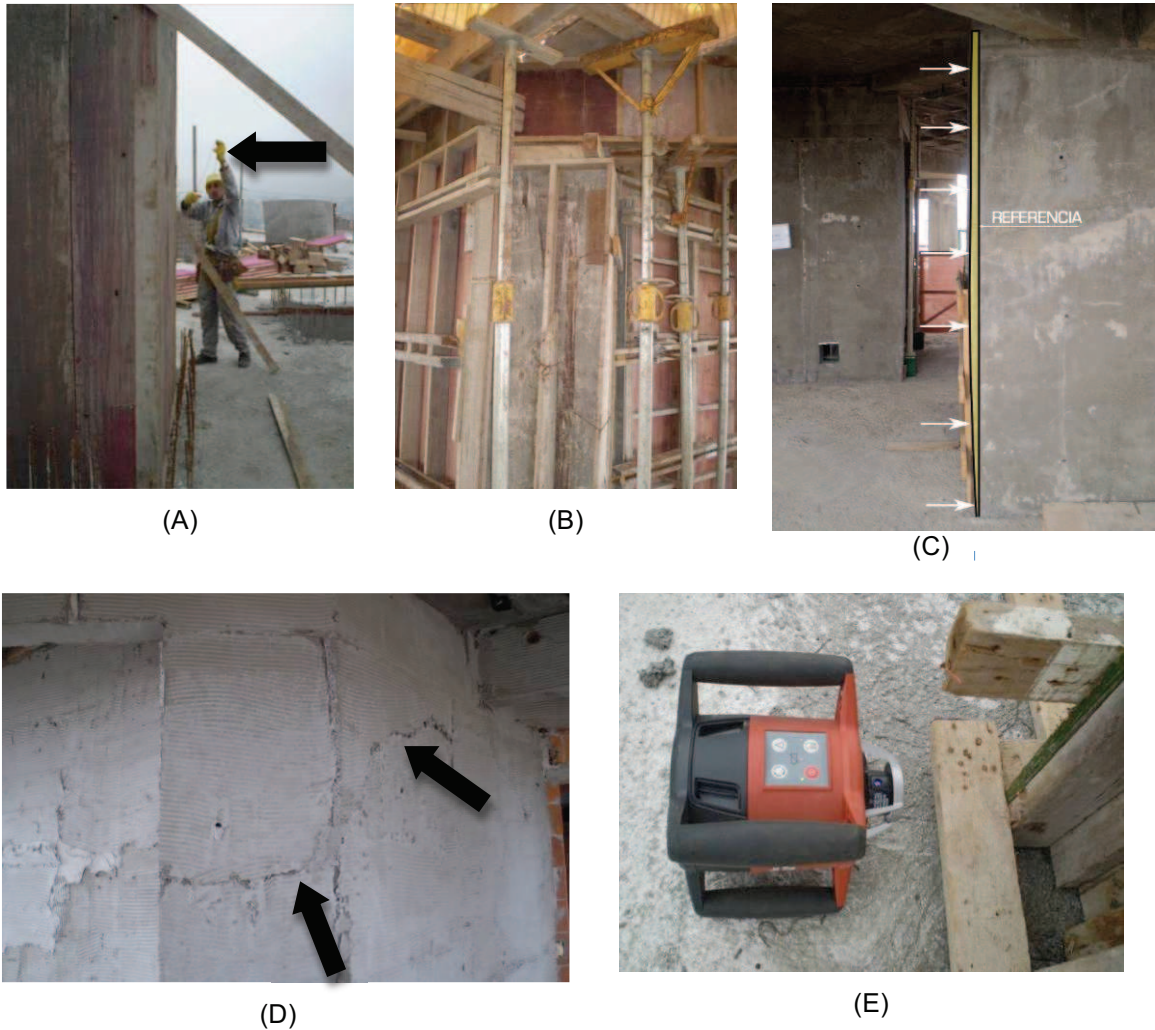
(A) Conferencia de prumo do Pilar. (B) Fôrmas do Pilar. (C) Deformação na Geometria do Pilar. D) Falhas concretagem Pilar. (E) Prumo Laser.
